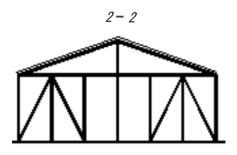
Схема каркасного здания при шарнирном опирании стоек на фундаменты и шарнирном примыкании к элементам кровельного покрытия
